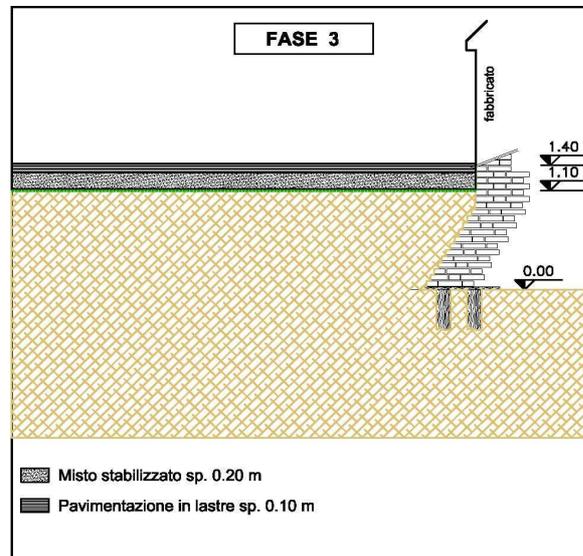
Fasi di intervento e sezione tipo di ripristino altimetrico del 3° lotto – area di scari fica
